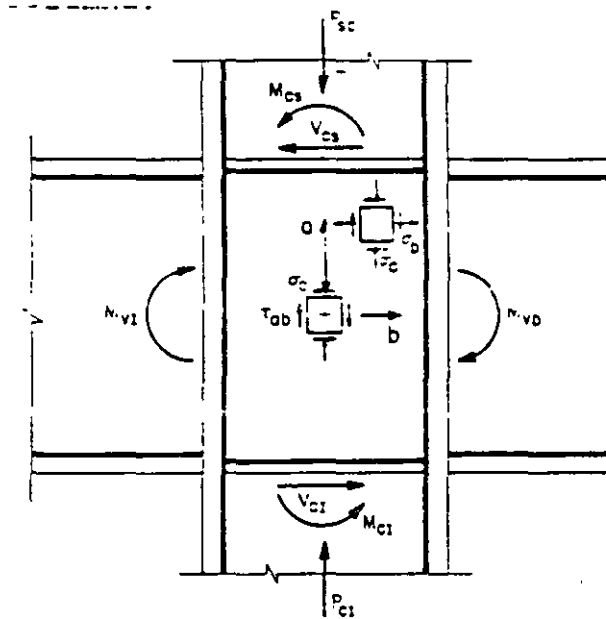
Esfuerzos en el alma de la columna en una junta
